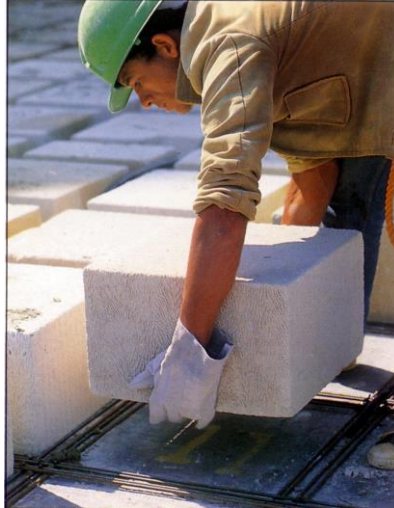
Laje nervurada moldada no local com enchimento em bloco de concreto celular autoclavado (FONTE: ATEX BRASIL, s/d).
